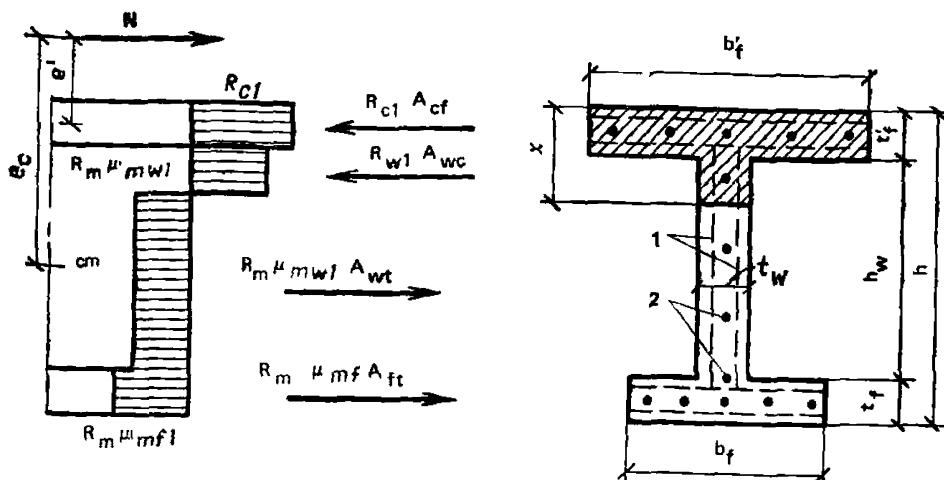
Схема усилий и эпюра напряжений во внерадиально сжатых элементах двутаврового сечения при $x > t_f'$
